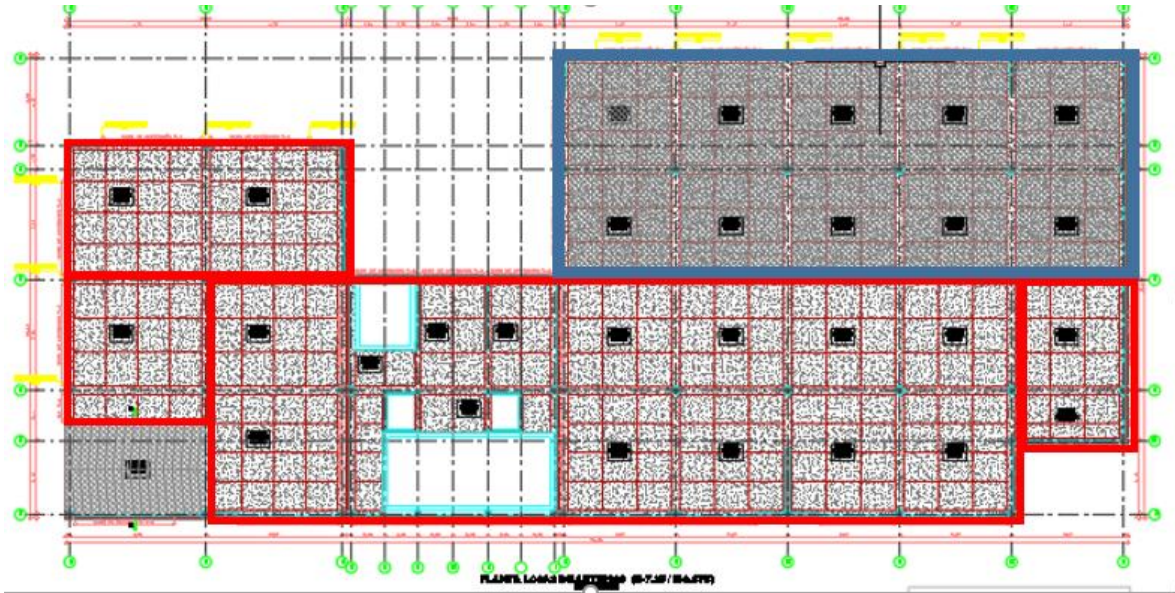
A.4 Plano en planta de contrapiso. Fuente: 59-EST-LABORATORIOS MECANICA 07-02-2017
